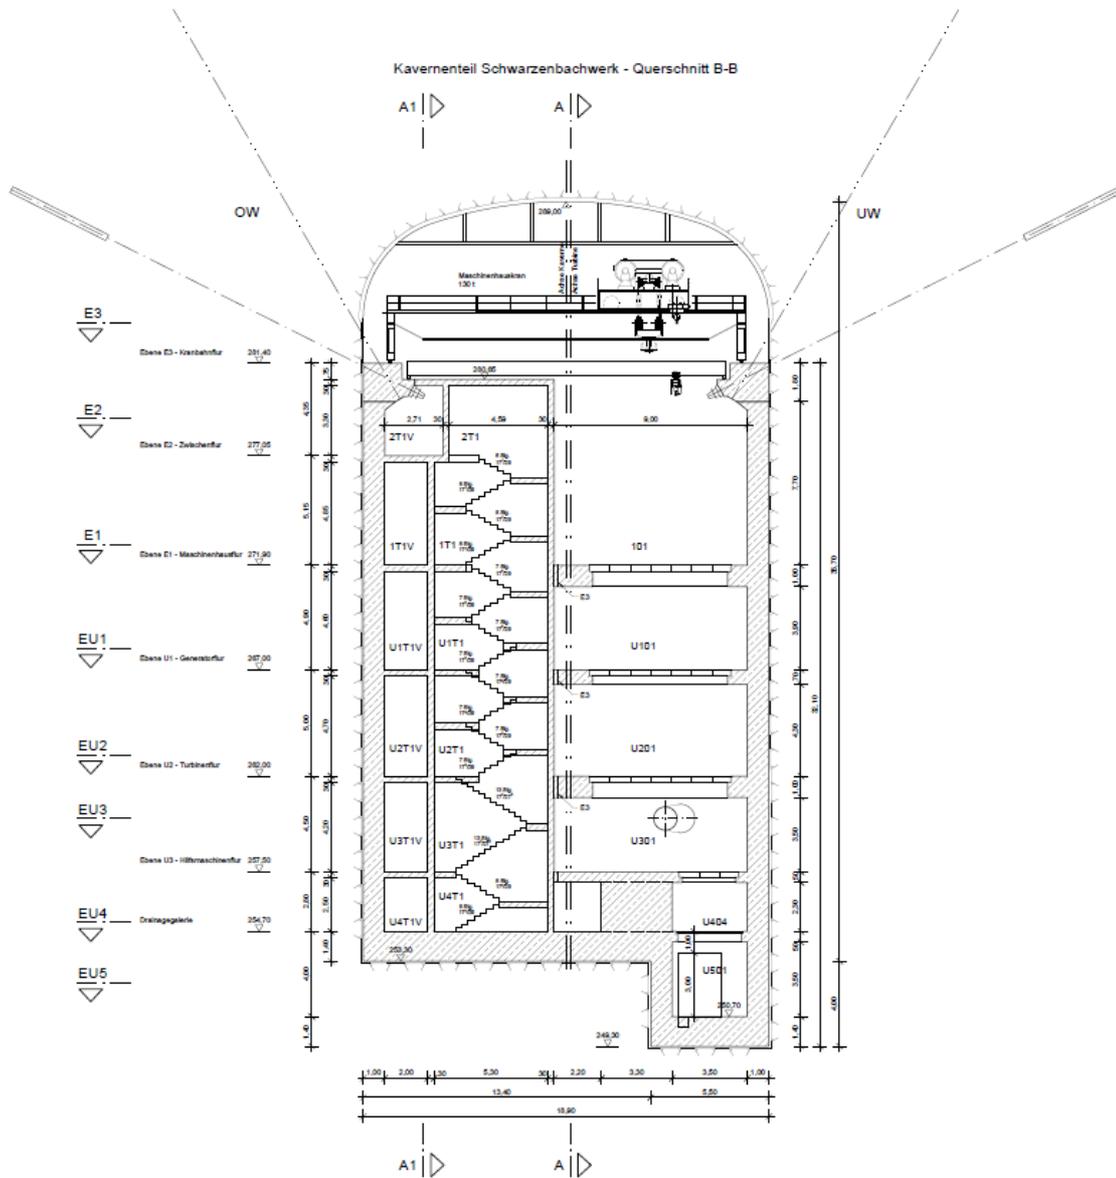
Kavernenteil Schwarzenbachwerk, Querschnitt B-B durch Treppenhaus T1 (West und Montageschacht (Auszug Anlage B.V.2.3)
